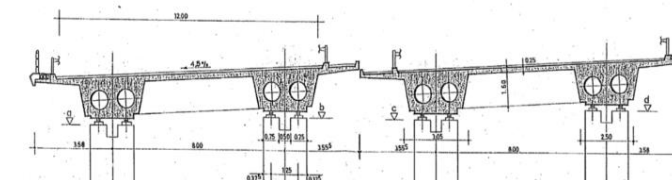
Desenho de projeto da estrutura do tabuleiro em laje nervurada (corte transversal)
